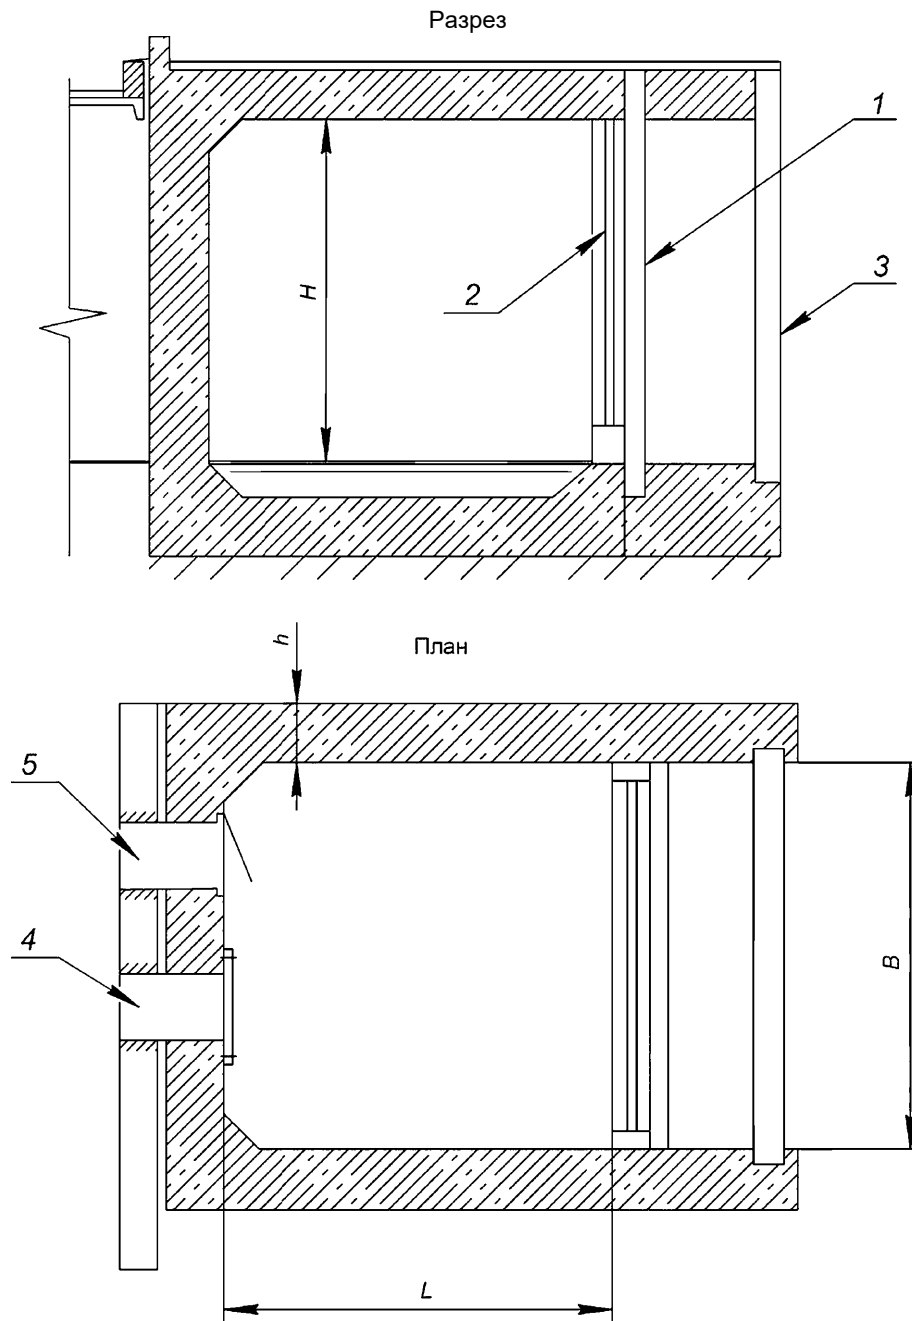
Железобетонная кабина с перфопанелью:
